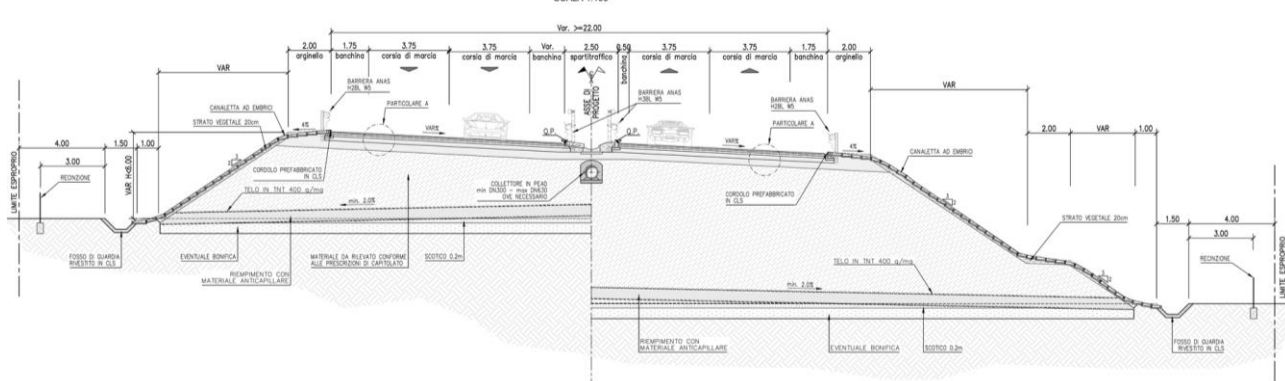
Sezione tipo in rilevato dell'asse principale con banche intermedie laterali
